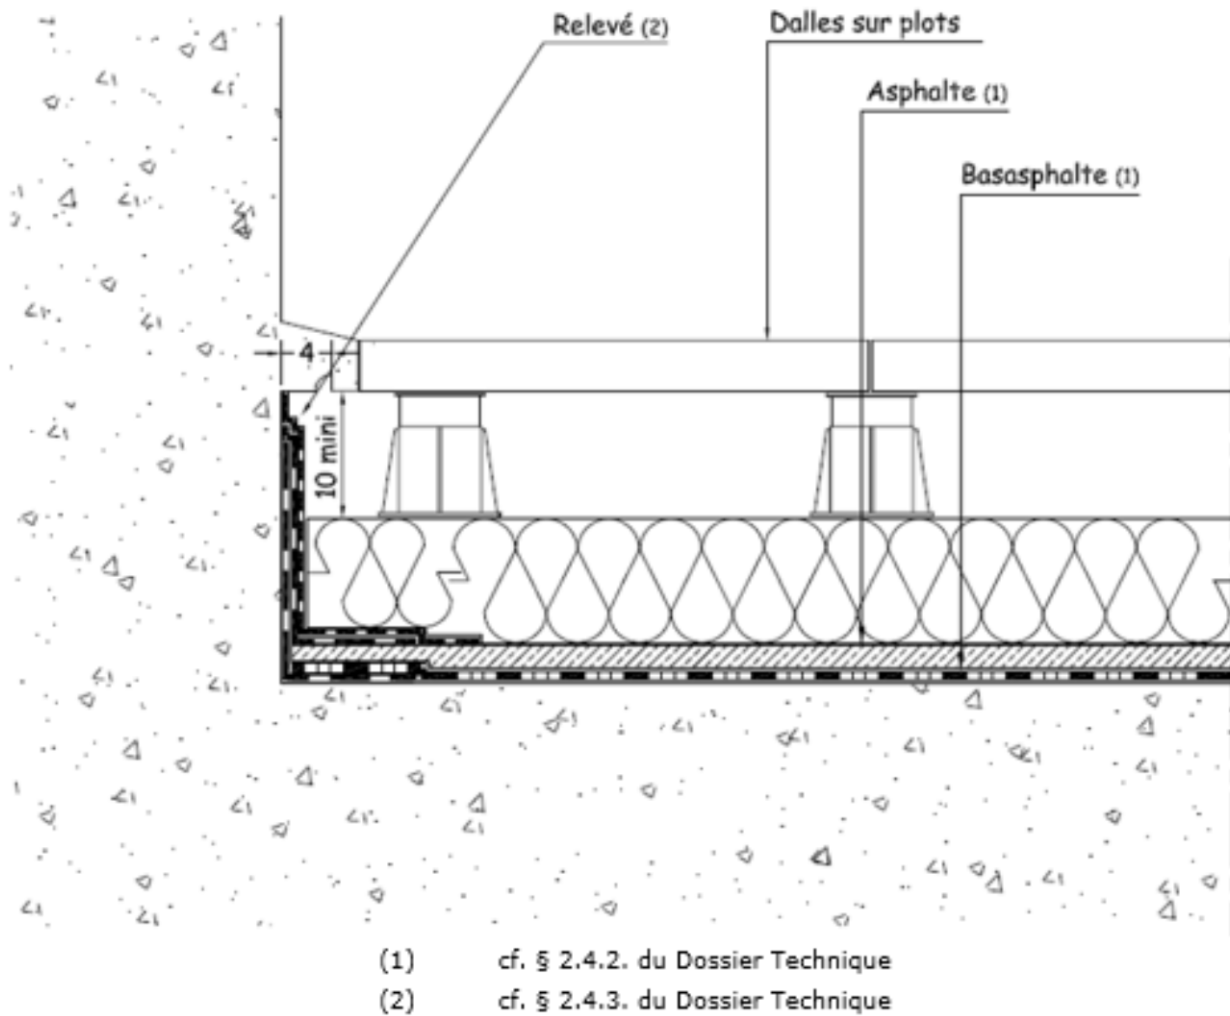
Coupe sur relevés en terrasse accessible aux piétons, protection par dalles sur plots, et isolation inversée
